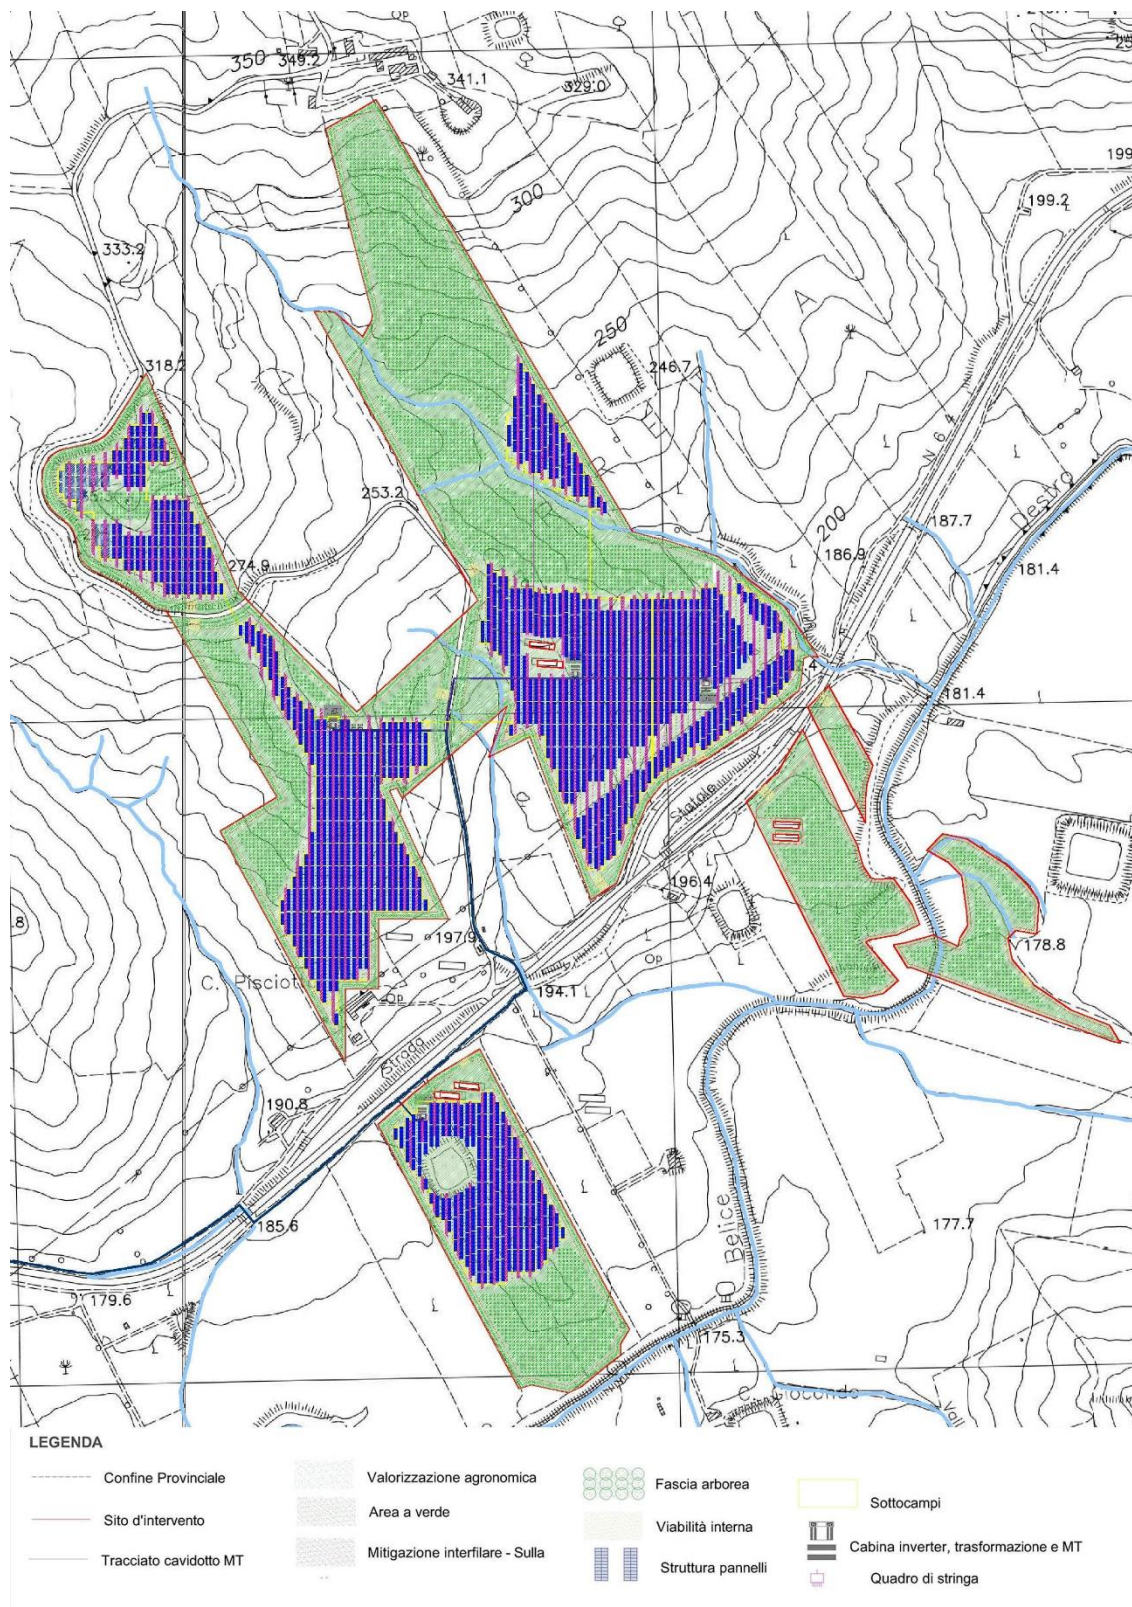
B – Layout dell'impianto ricadente in Contrada Torretta con cavidotto
